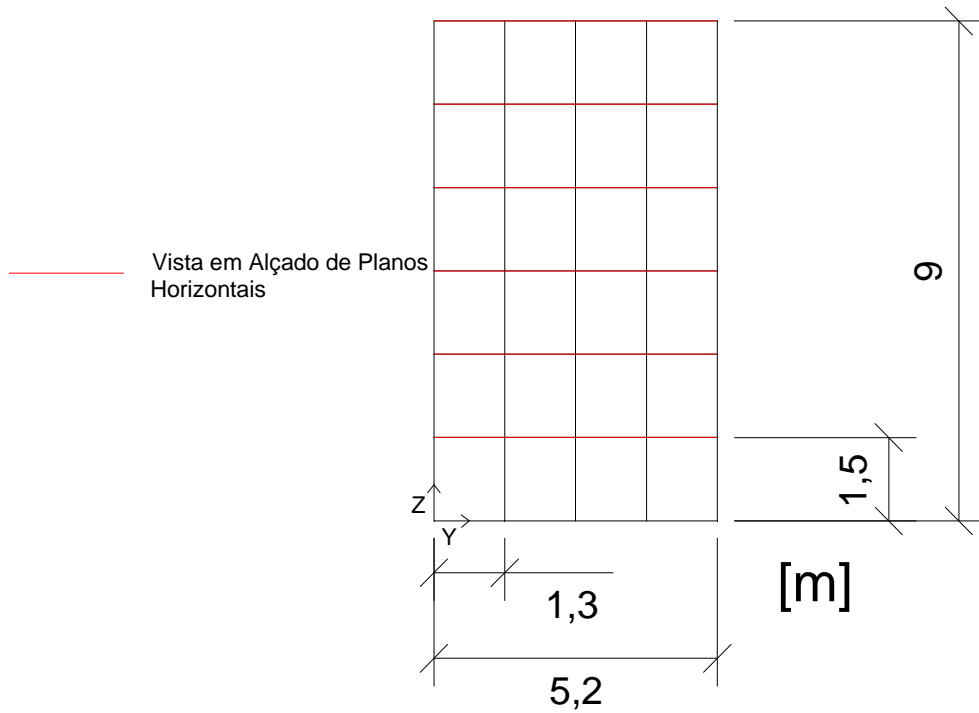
Vista em Alçado dos Planos Horizontais no Cembre ao Solo Para Uma Secção Tipo de Um Viaduto Com 20 m de Vão
